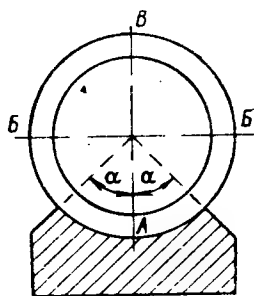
Опириание трубопровода на железобетонную сплошную опору
